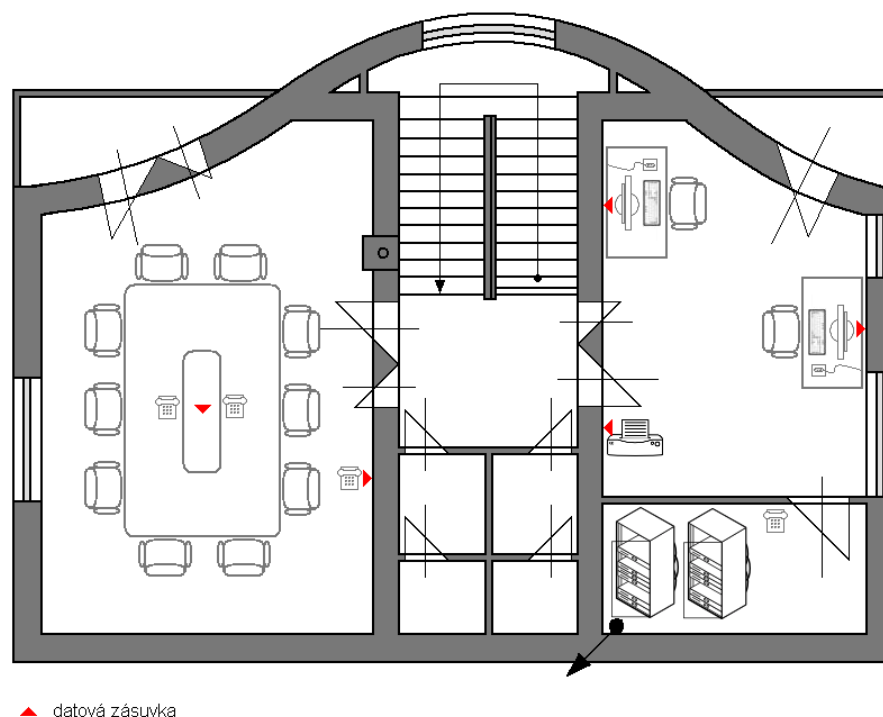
navrhovaná pracovní místa v druhém nadzemním podlaží Zdroj: vlastní
